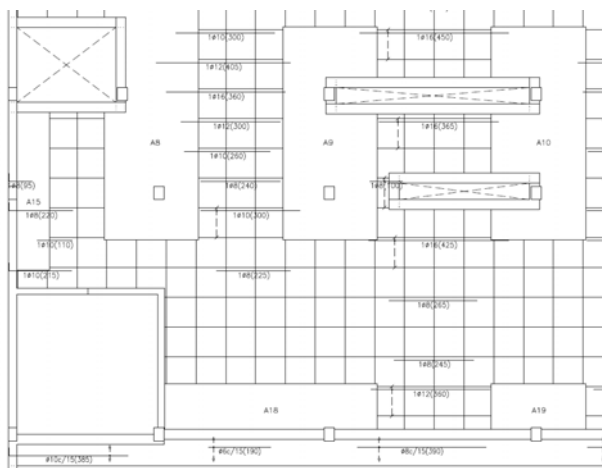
Armadura longitudinal inferior necesaria tras la intervención
